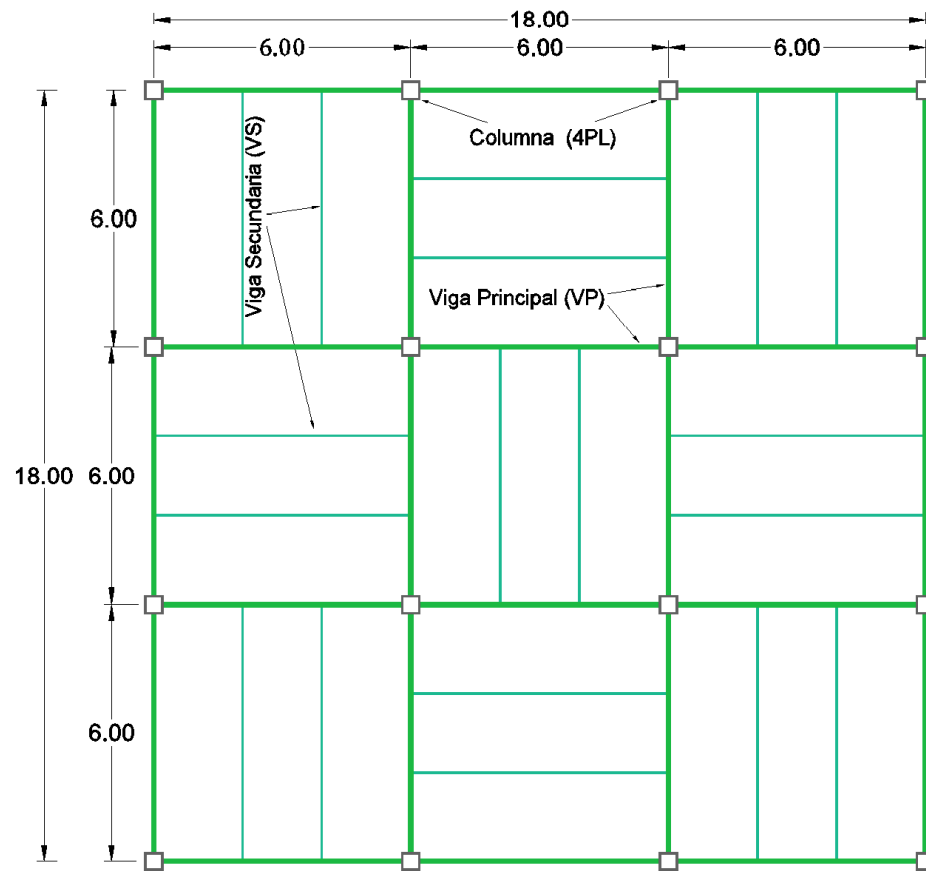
Geometría y dimensiones del modelo (Vista en planta).
